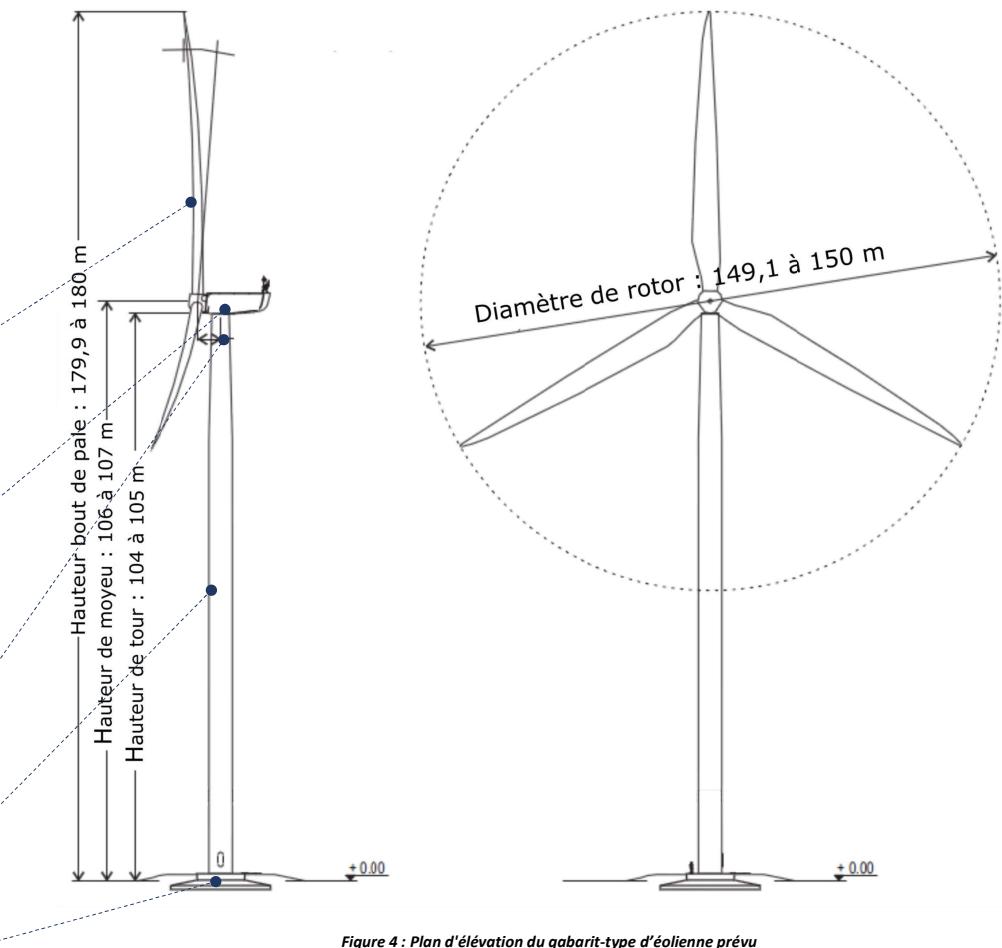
Plan d'élévation du gabarit-type d'éolienne prévu
